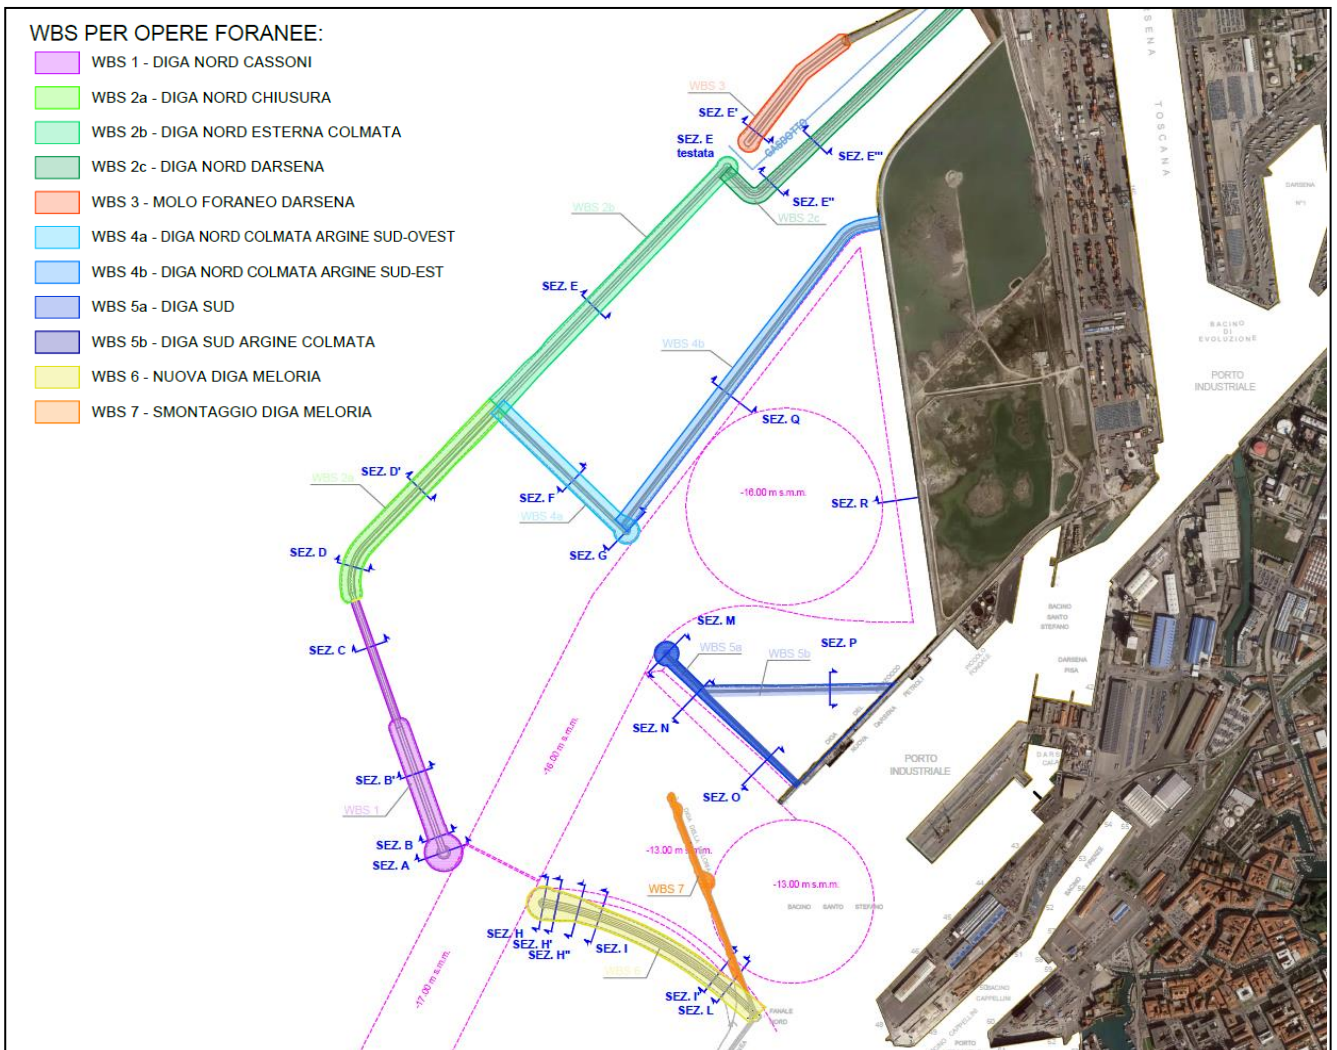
Planimetria con indicazione dei corpi d'opera e ubicazione delle sezioni tipologiche
